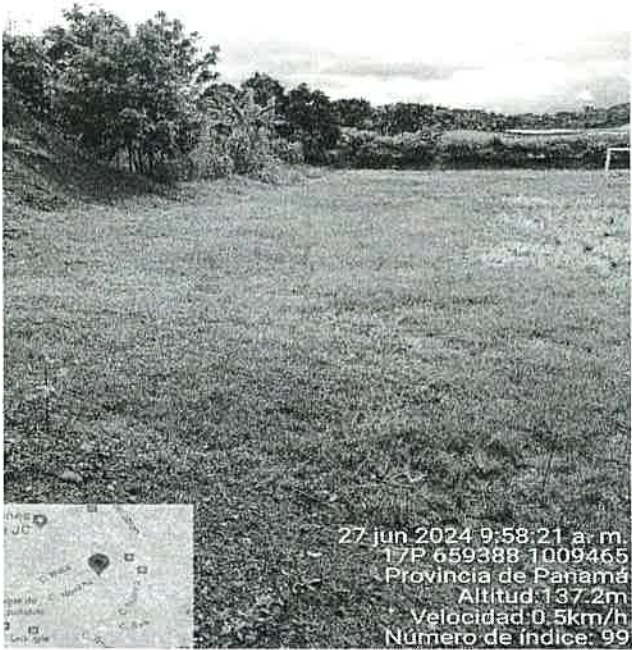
Se observa un terreno en el área del proyecto, que será habilitado para áreas verdes y parque recreativo.
